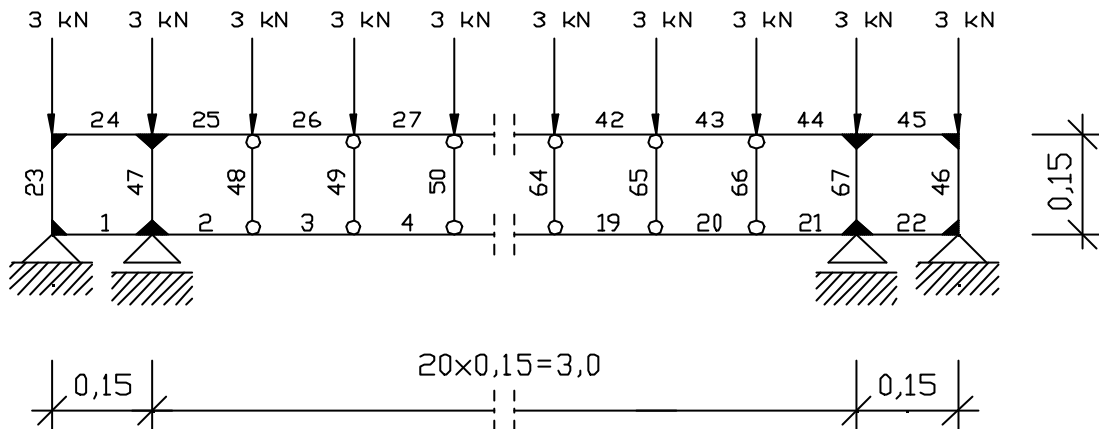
Ersatzmodell mit Stabnummerierung für Brettlagenholz mit orthogonaler Struktur
